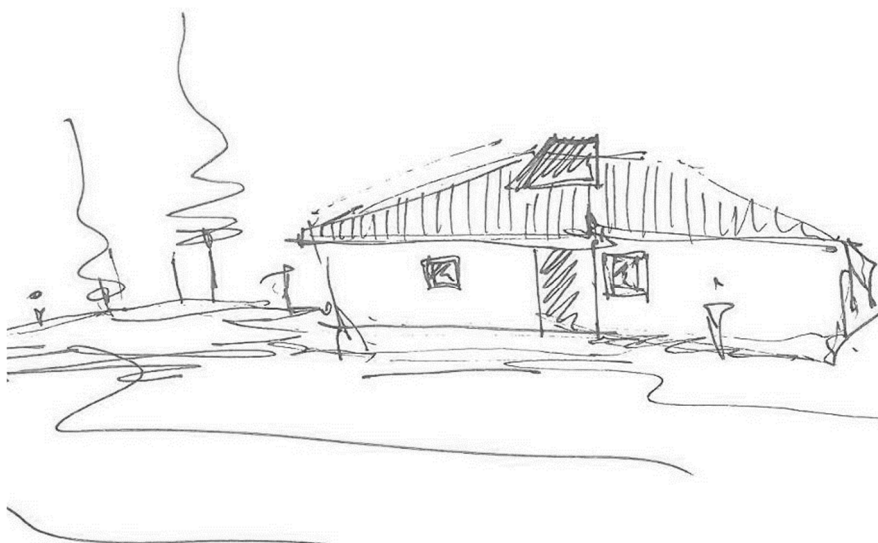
Casa florestal de Cunha – Alçado Sul
